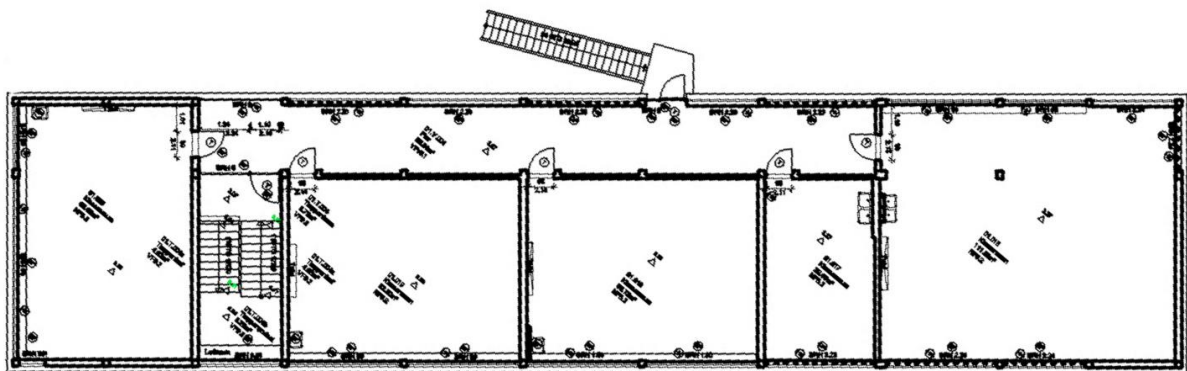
Ausschnitt 1. OG Grundriss Schulgebäude Trakt C
